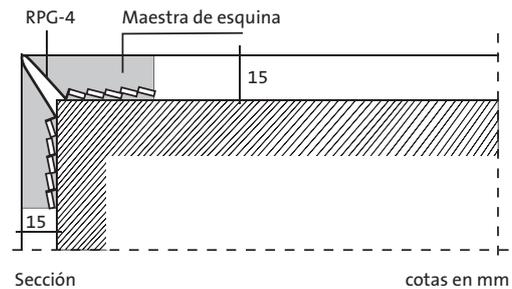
Guardavivos colocado (NTE-RPG 74)
